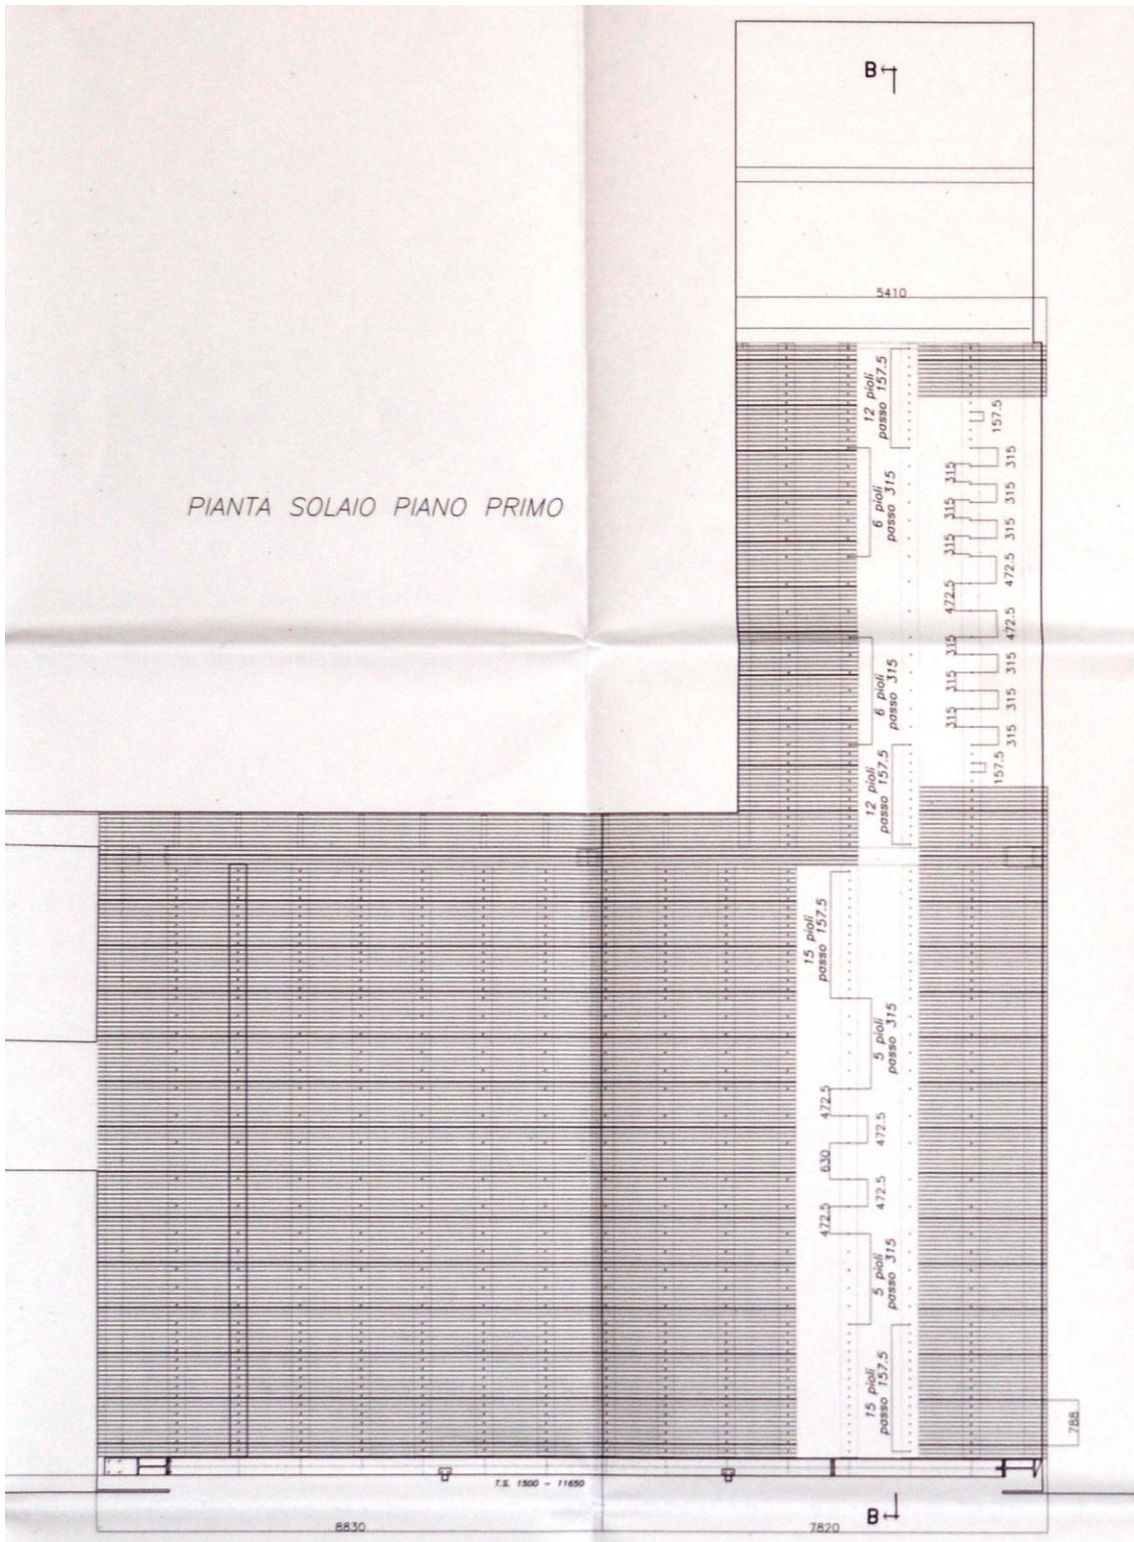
Particolare di A.2003.a.us.b.T06 - Pianta lamiere grecate - Pianta piano primo
